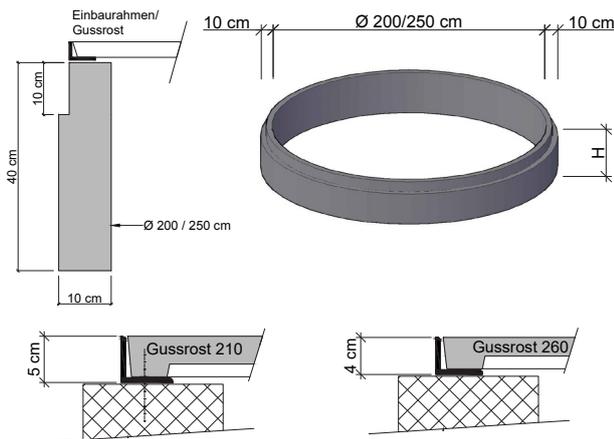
Unterbau Typ Ronda mit Zementrohr o. Streifenfundament
